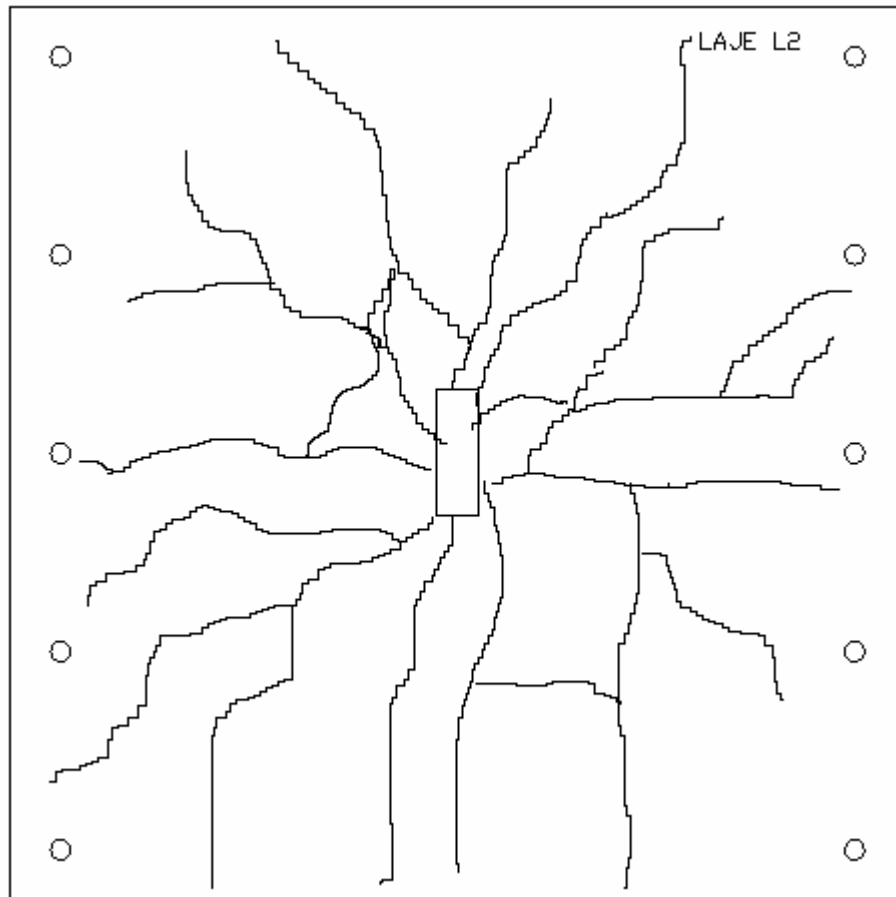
Mapa de fissuração da laje L2
